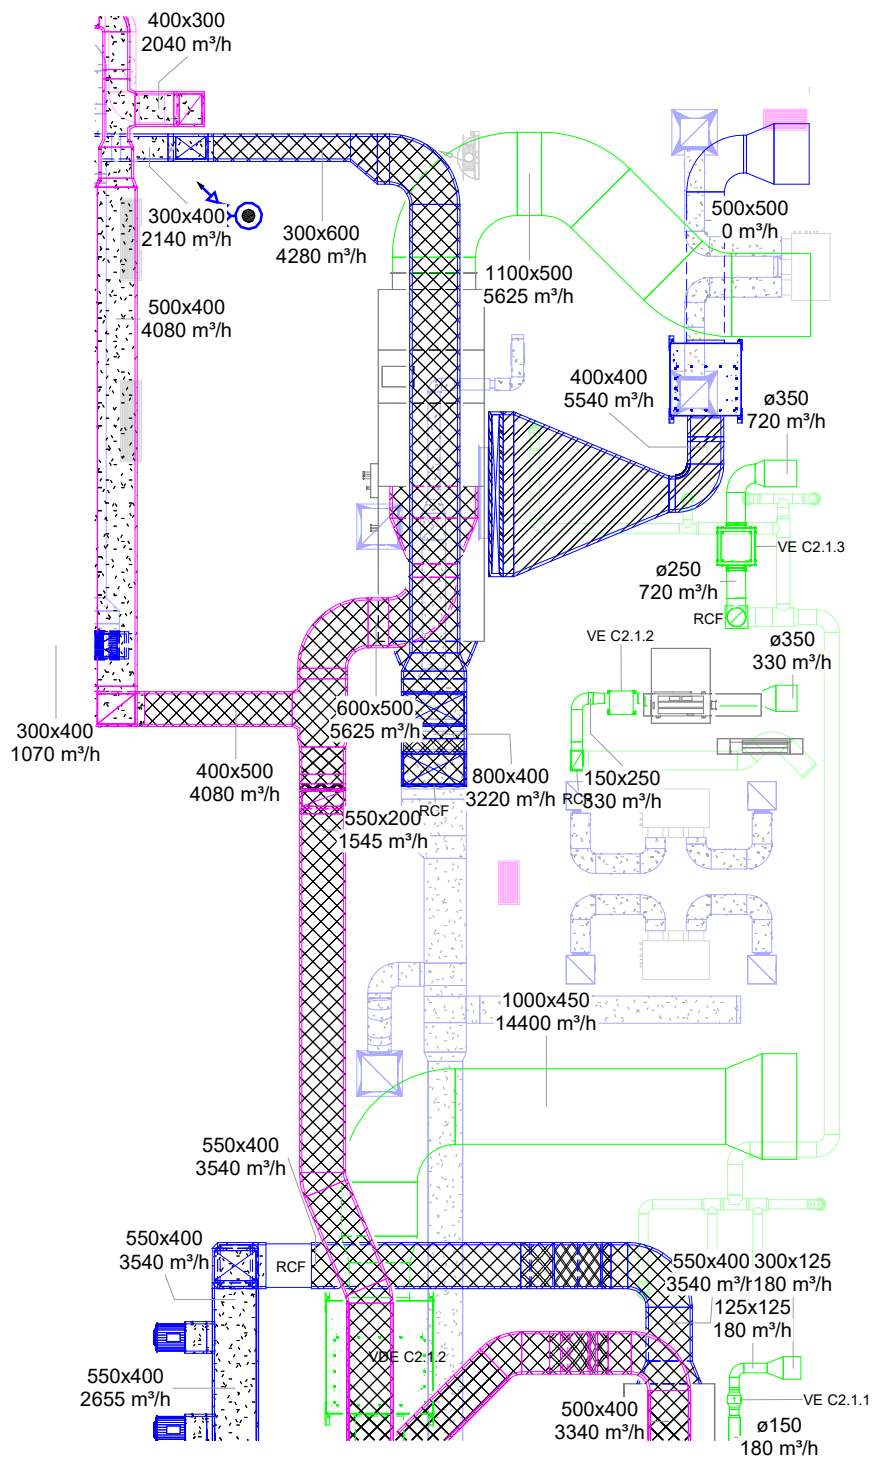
Seção 2.5 da planta geral do traçado das condutas na mezzanine à escala 1:100.
